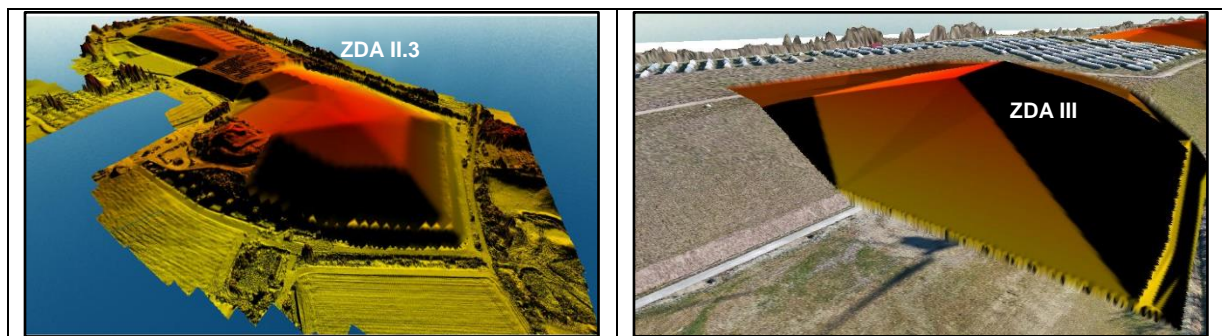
Erweiterungsflächen mit profilierter Oberflächenabdichtung
